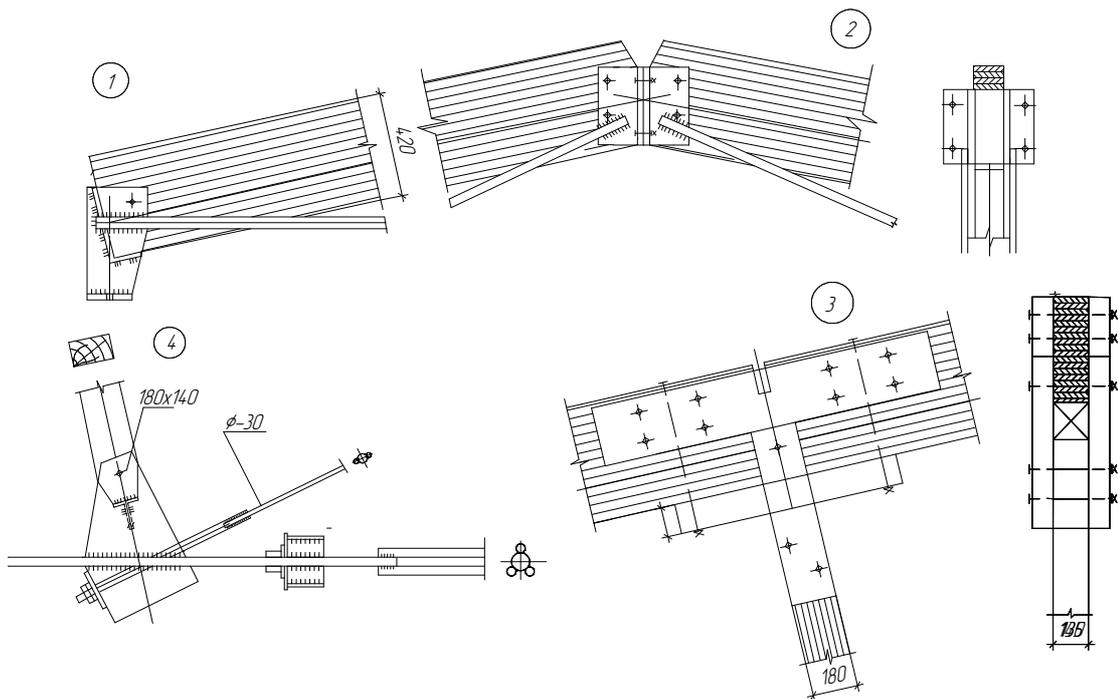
Типовая треугольная металлодеревянная ферма с клееным верхним поясом с номинальным пролетом 21 м
